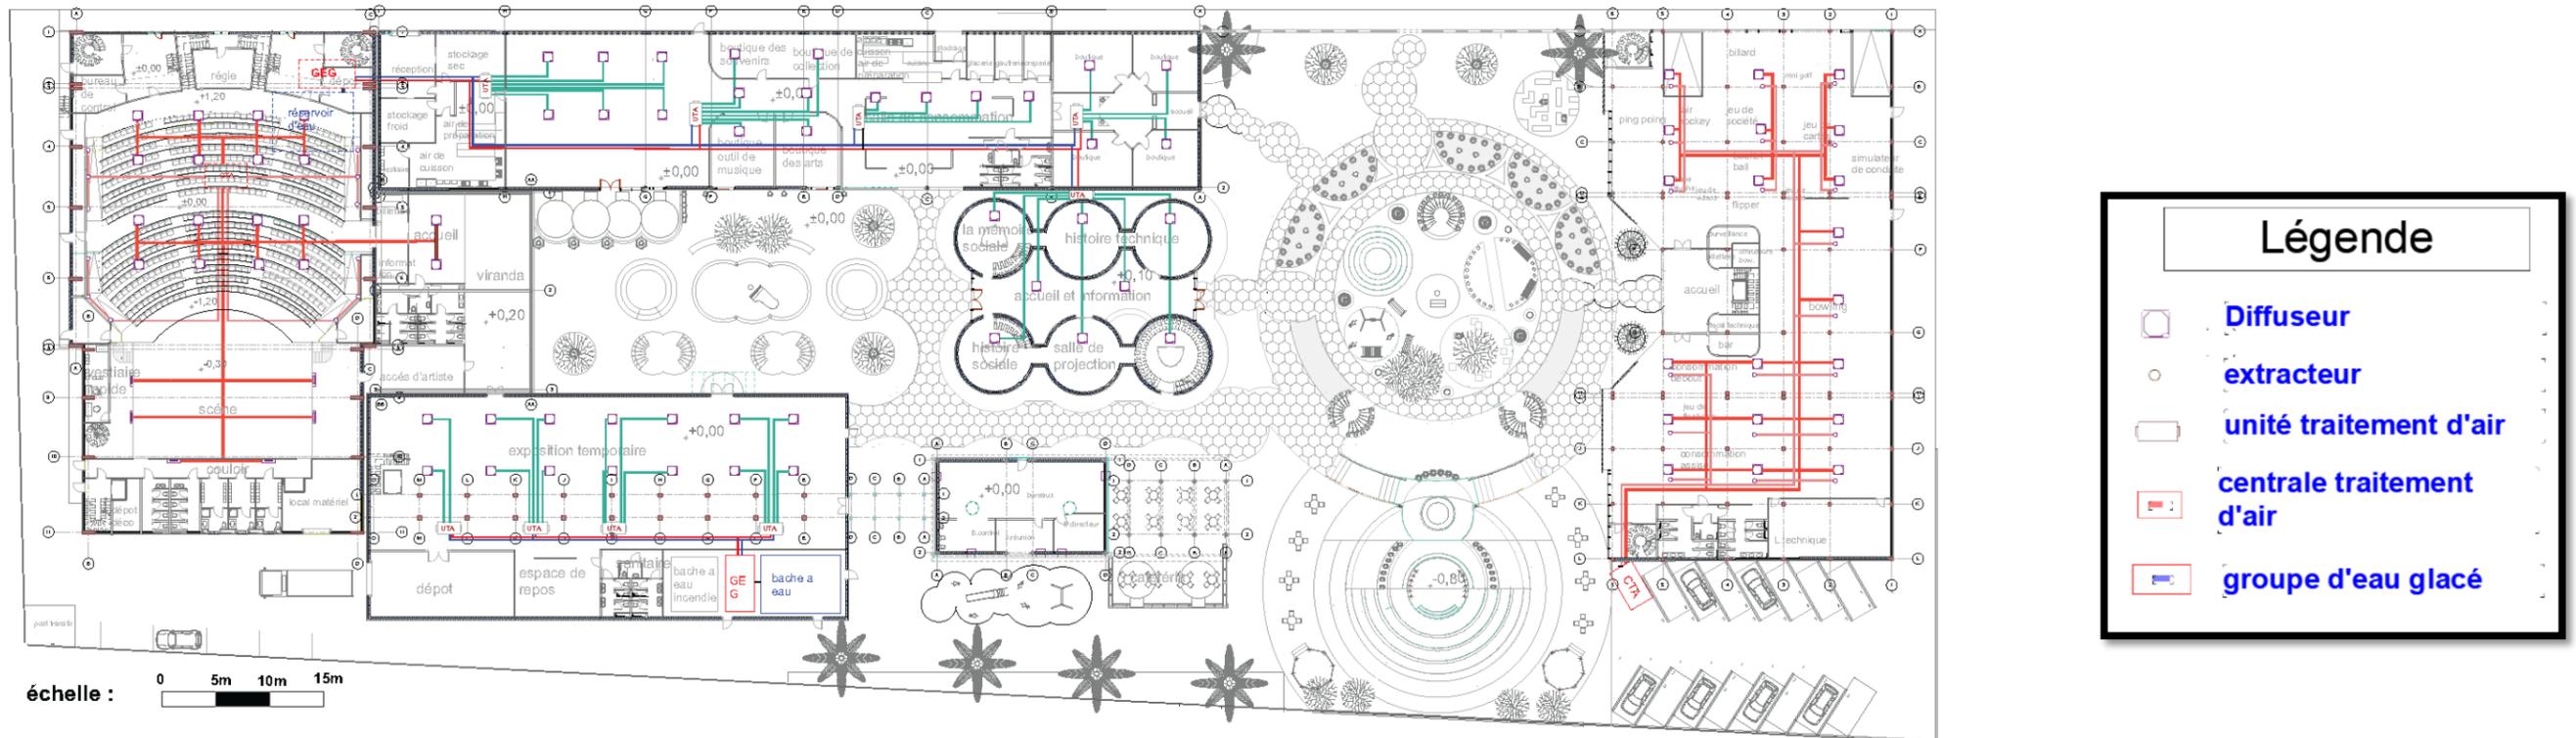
plan de climatisation rez-de-chaussée 1/600.
